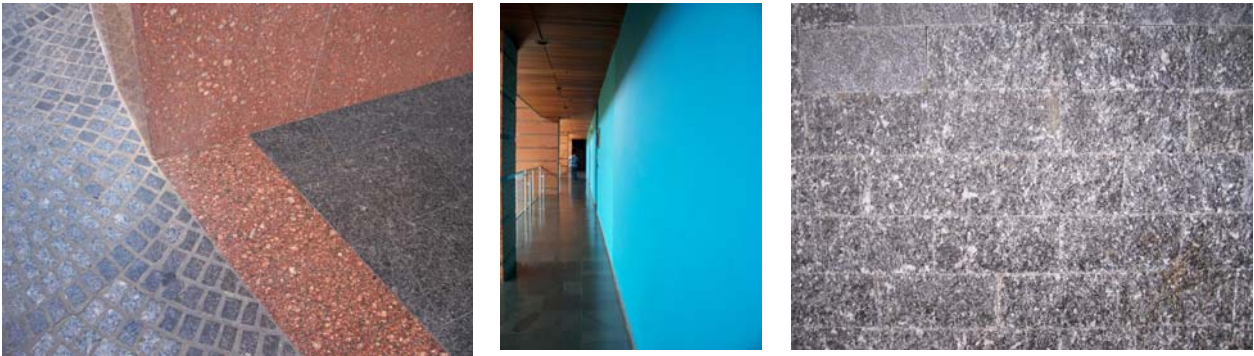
Fotos pavimentos de mármol, paramentos con enlucido y pintura –plafón de techo en madera, pasamanos de vidrio y, piedra azul cortada en paramento.
